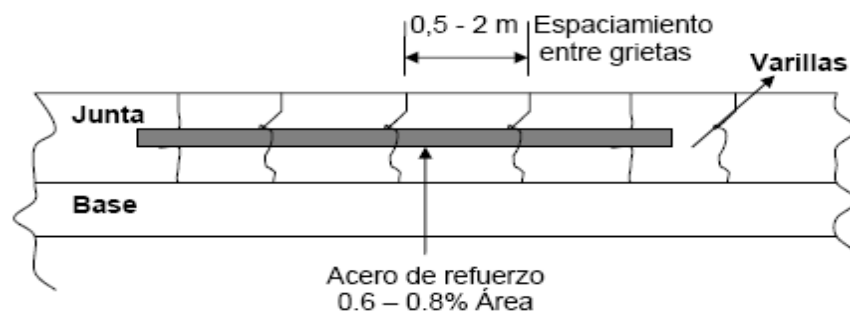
Pavimento de concreto con refuerzo continuo (CRCP).
